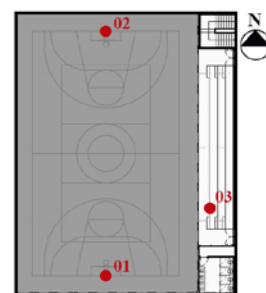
Planta baixa com a posição das câmeras para as Luminâncias
